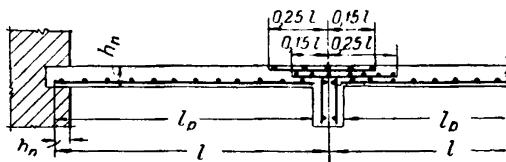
Армирование плит над опорами двумя сварными сетками с поперечным расположением рабочих стержней
